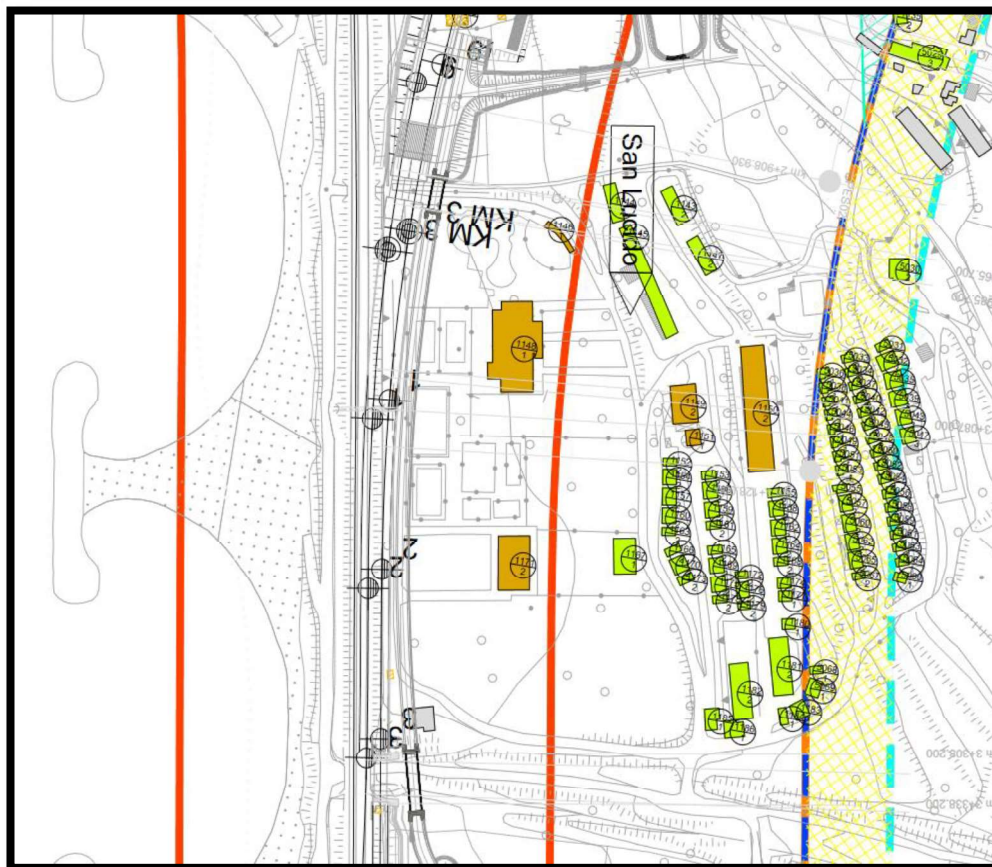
Stralcio studio acustico aggiornamento gennaio 2024
